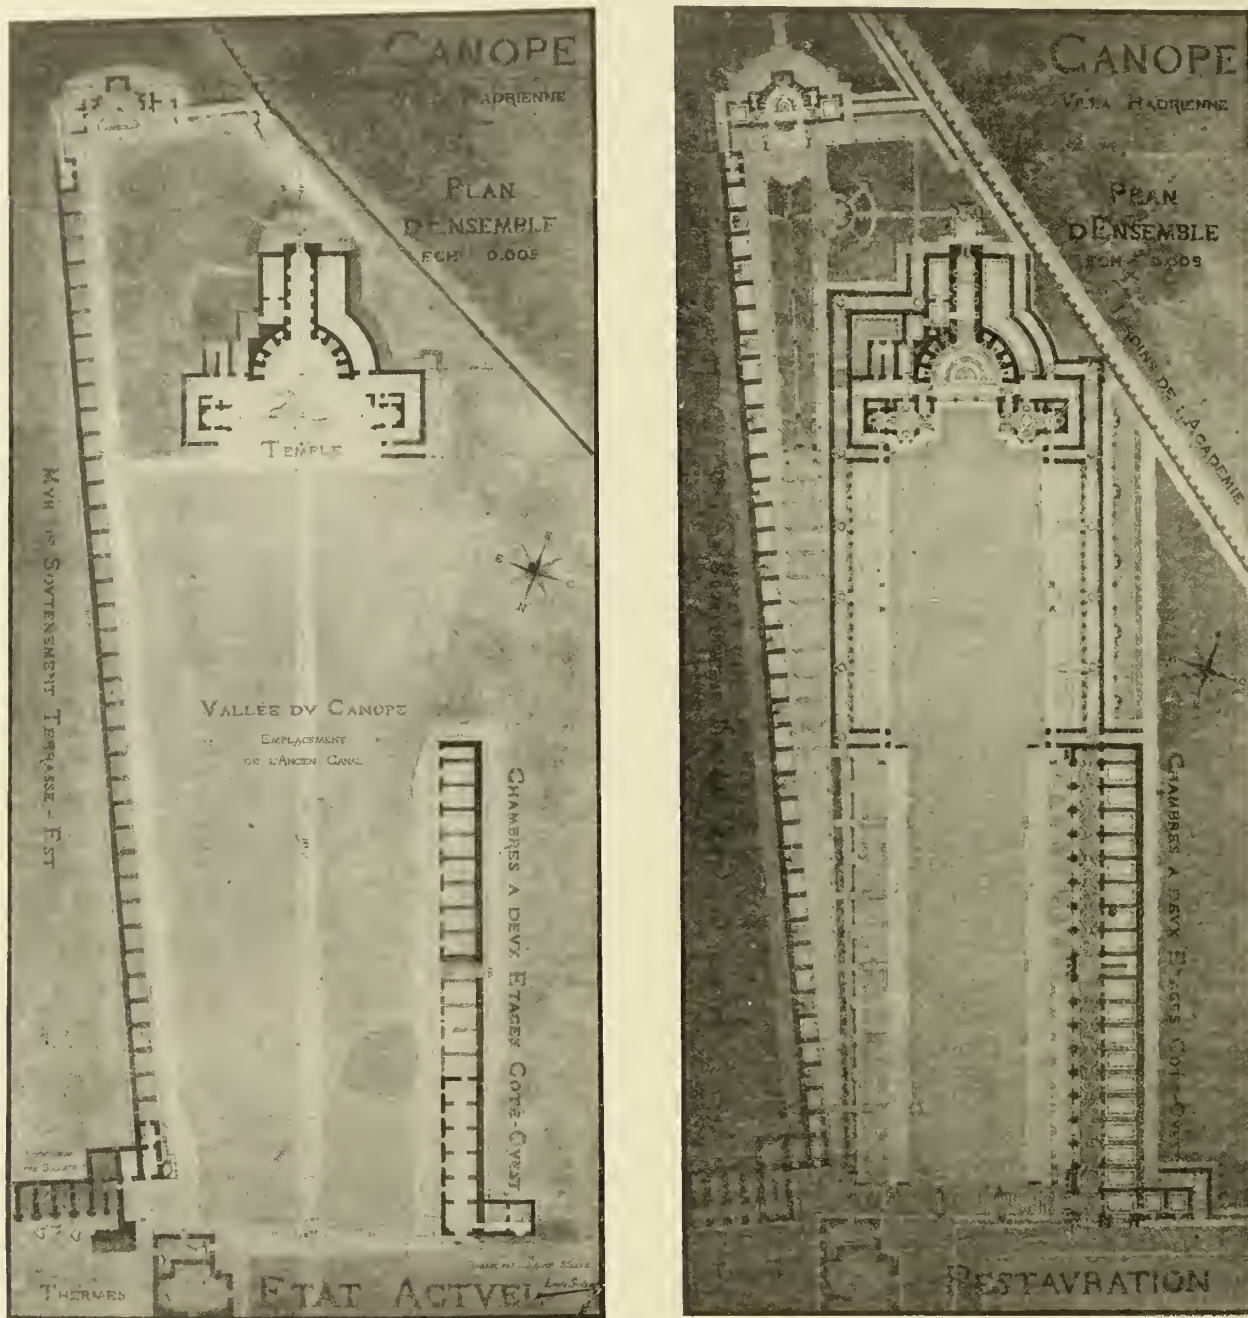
PLAN DU CANOPE (ÉTAT ET RESTAURATION, PAR M. SORTAIS).
